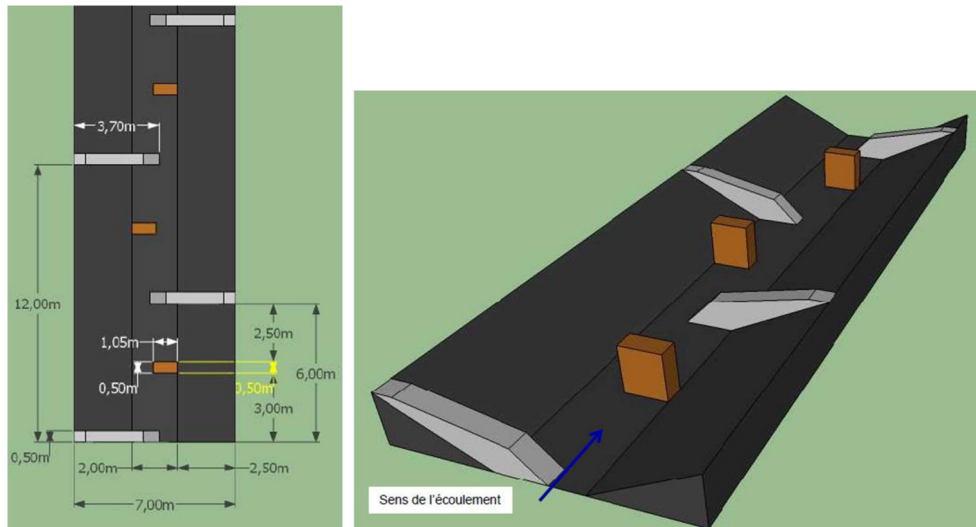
Vue en plan (à gauche) et vue 3D (à droite) de la configuration proposée à Malause
